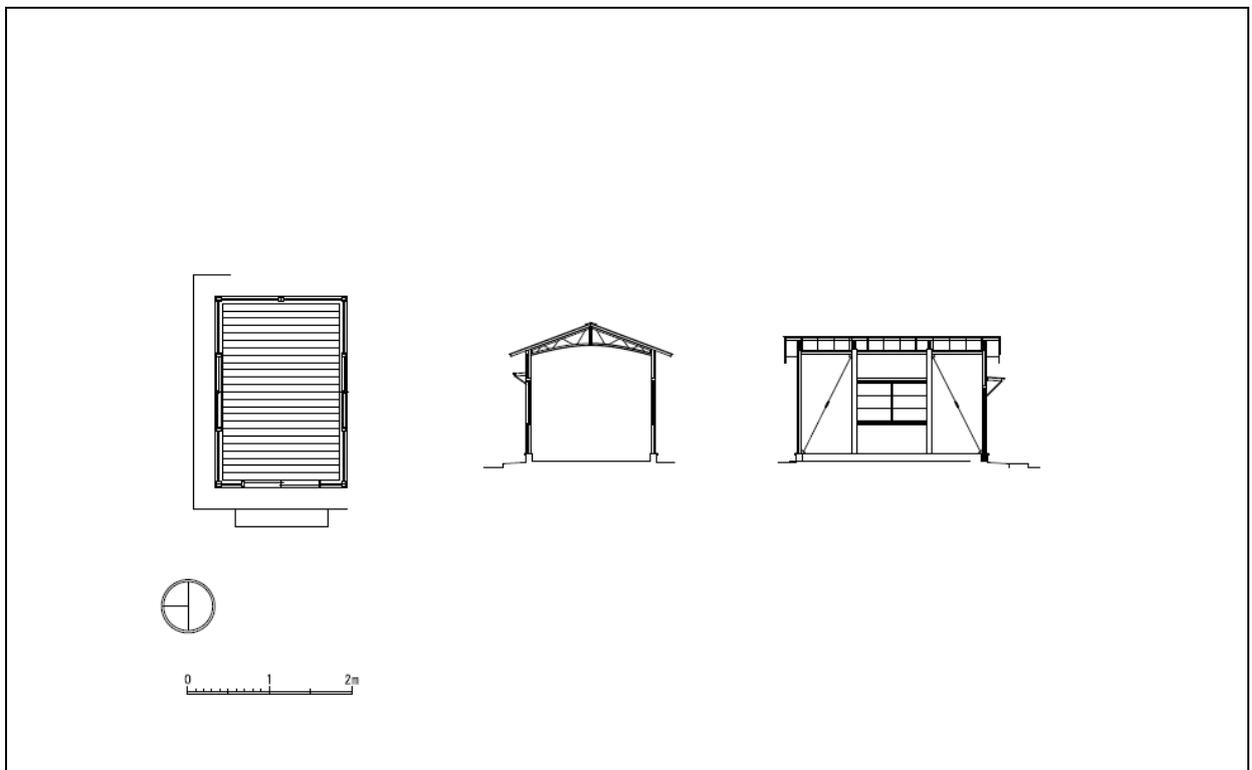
ヤンマーNo. 18 家庭工場 小屋 平面図及び断面図
